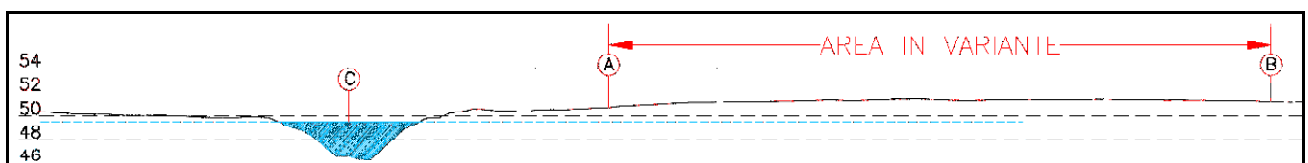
Restituzione sezione eseguita su rilievo LIDAR
